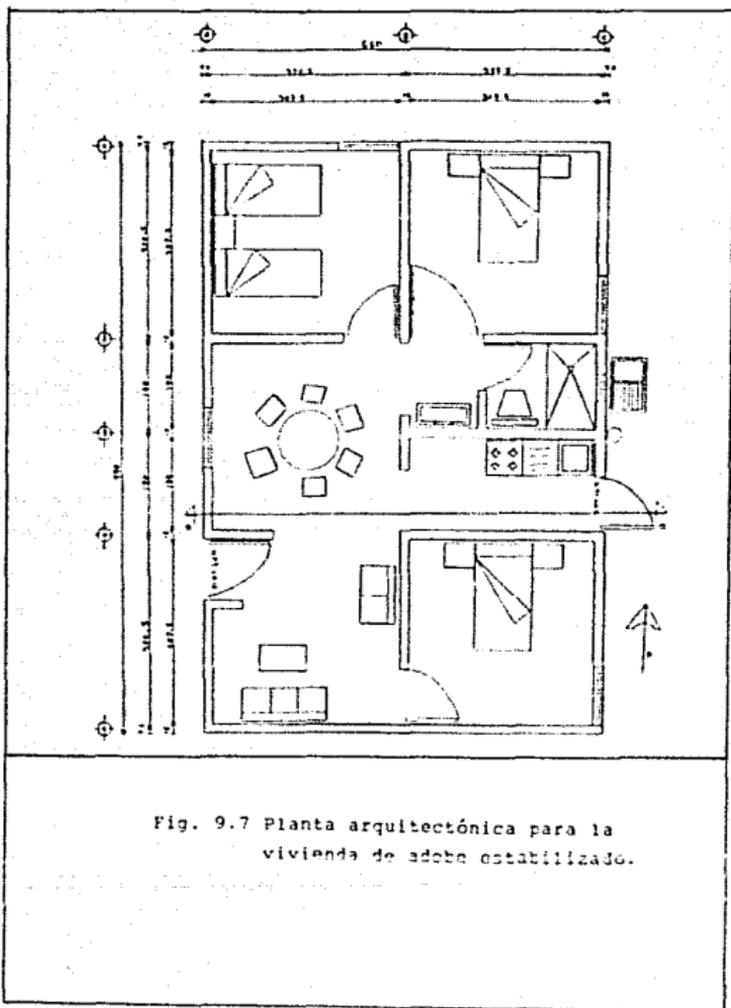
Planta arquitectónica para la vivienda de adobe estabilizado.
